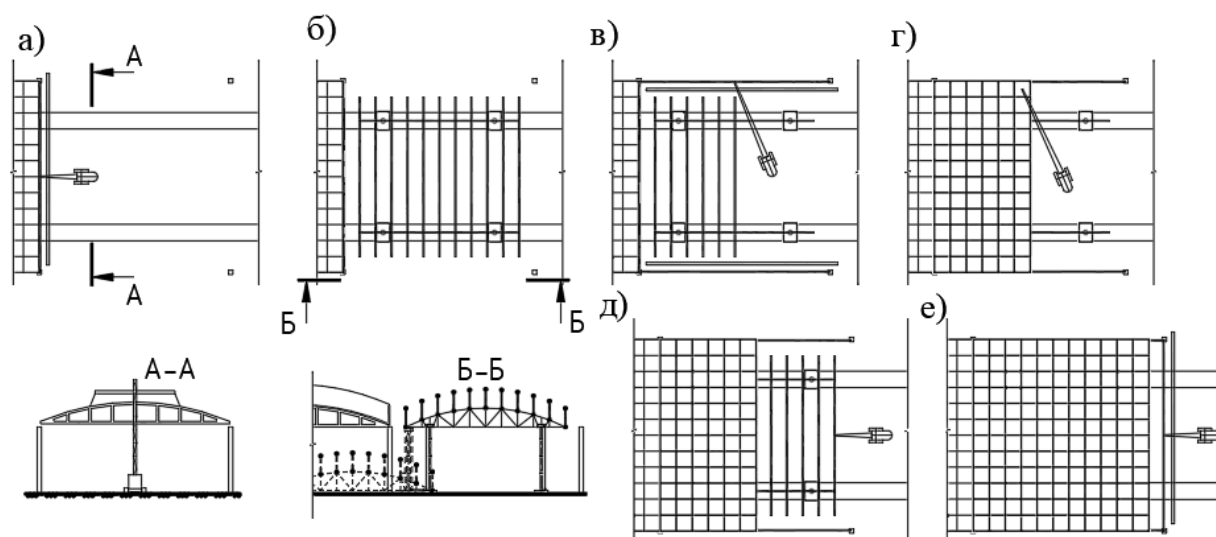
Монтаж железобетонных оболочек двойной положительной гауссовой кривизны с применением механизированного кондуктора: а – монтаж первой контурной фермы; б – установка и подготовка кондуктора к монтажу; в – демонтаж пяти кружальных ферм и монтаж второй и третьей контурной фермы; г – монтаж плит покрытия на первой половине оболочки; д – монтаж пяти кружальных ферм; е – установка четвёртой фермы диафрагмы и монтаж плит покрытия на второй половине оболочки
